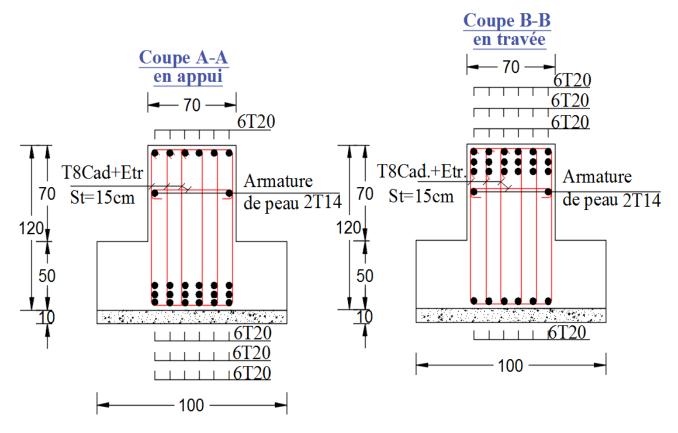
Schéma de Ferraillage du radier nervuré
